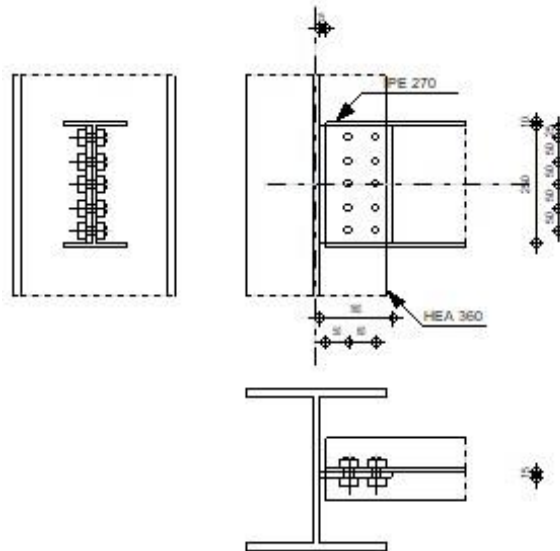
Vue détail de l'assemblage poteau poutre secondaire
